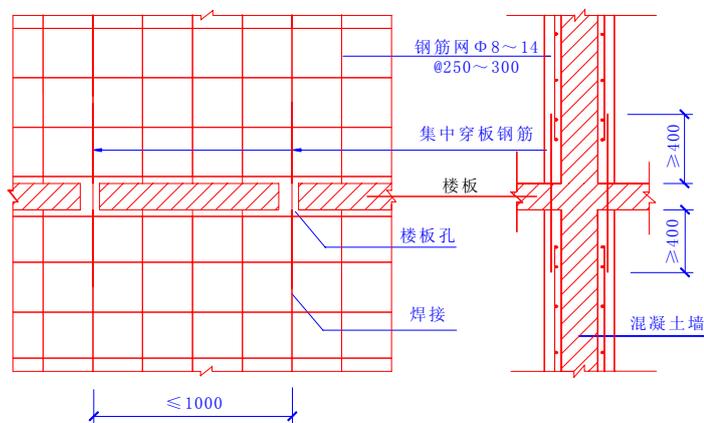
夹板墙加固钢筋网过楼板的穿孔集中配筋
